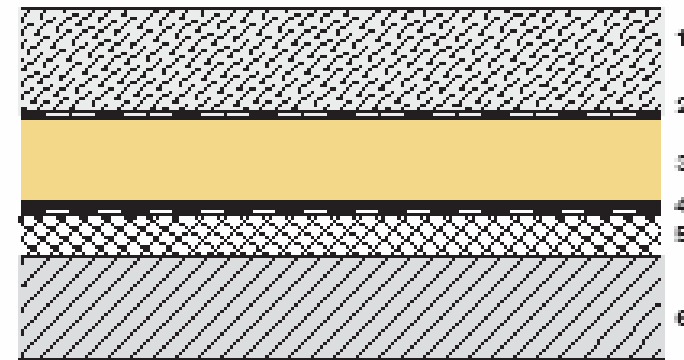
Stratigrafia di tetto rovescio carrabile con pavimentazione in calcestruzzo armato
